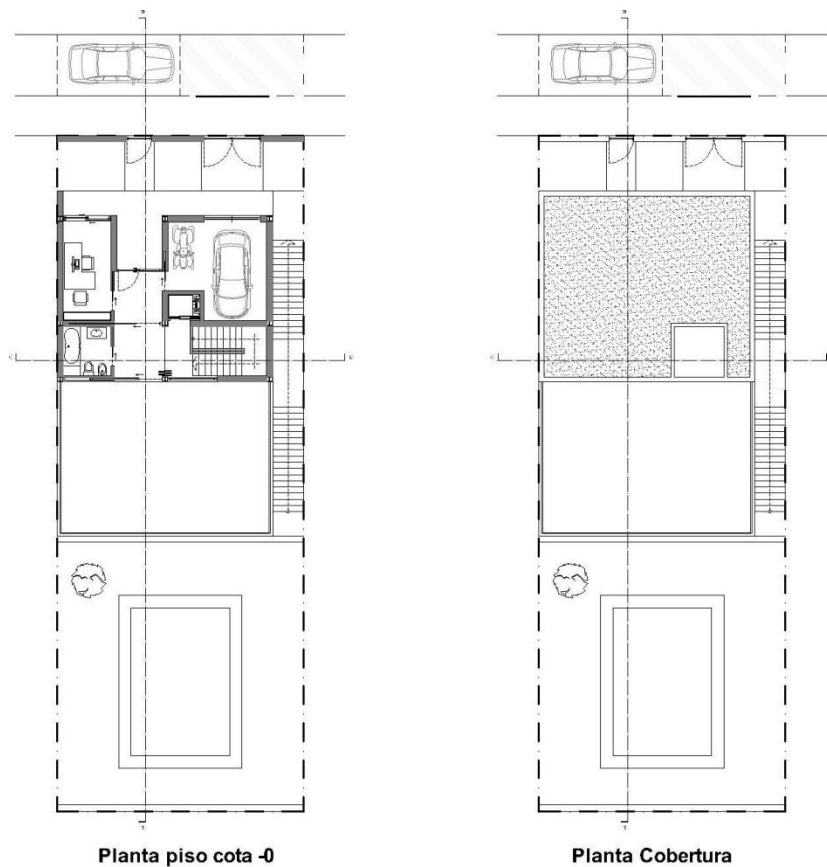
Plantas piso cota -0 e cobertura (2ª fase)
